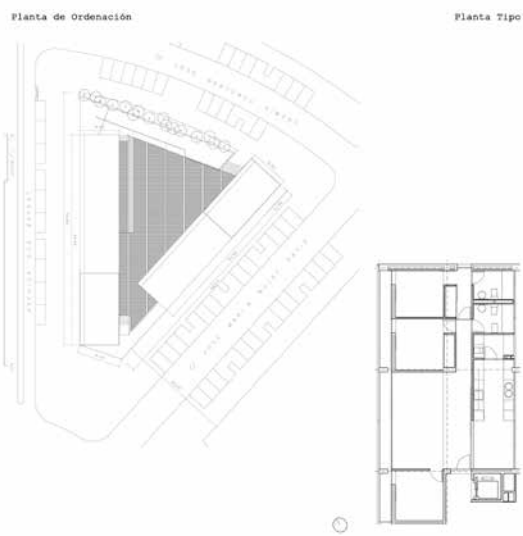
Caso 4. Planta de ordenación y de vivienda tipo.
